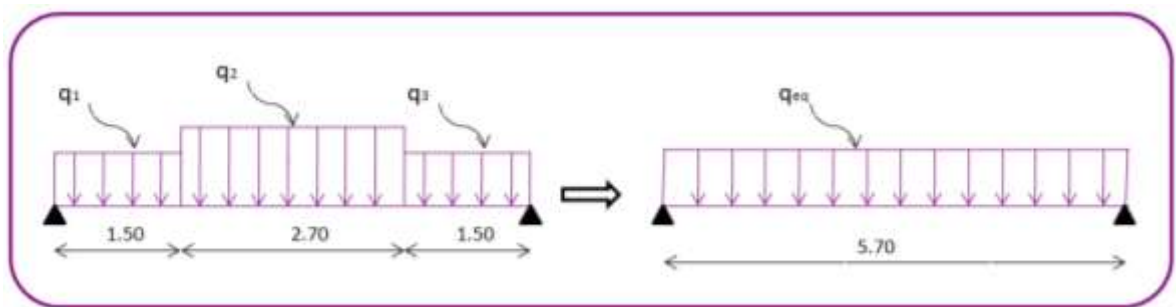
Schéma statique de volée de l'escalier sur limon central.
